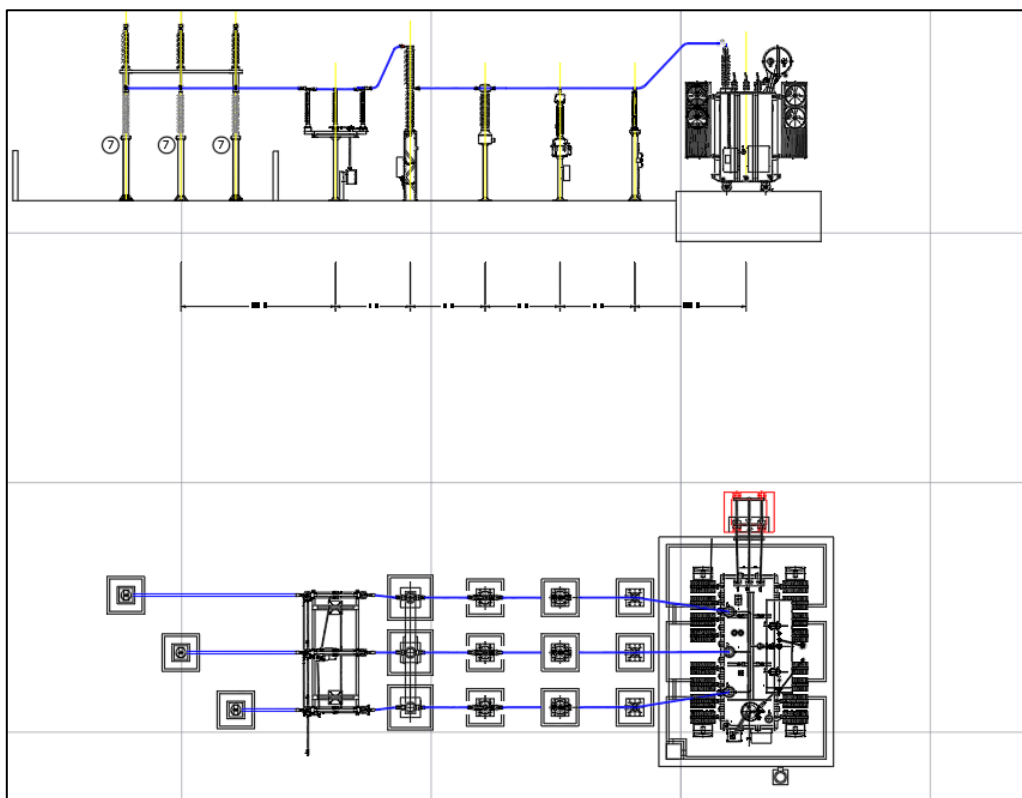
Vista in pianta e vista laterale stallo di trasformazione
